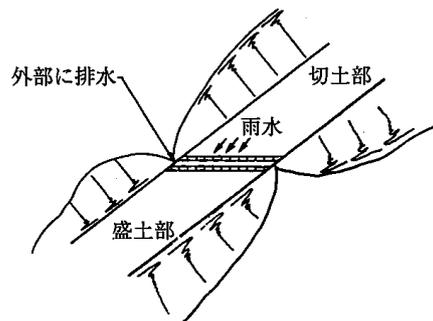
切り盛り境の素掘り排水溝の例³⁾
